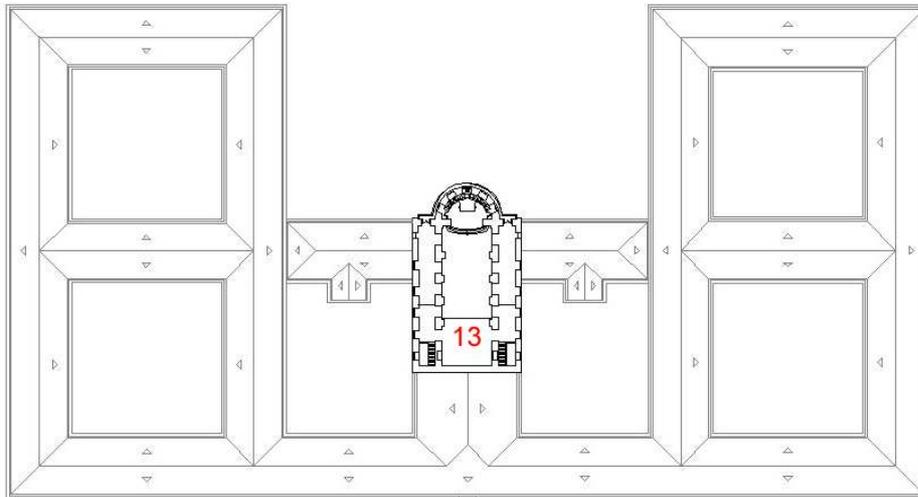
Planta de áreas em destaque no 3º pavimento.
